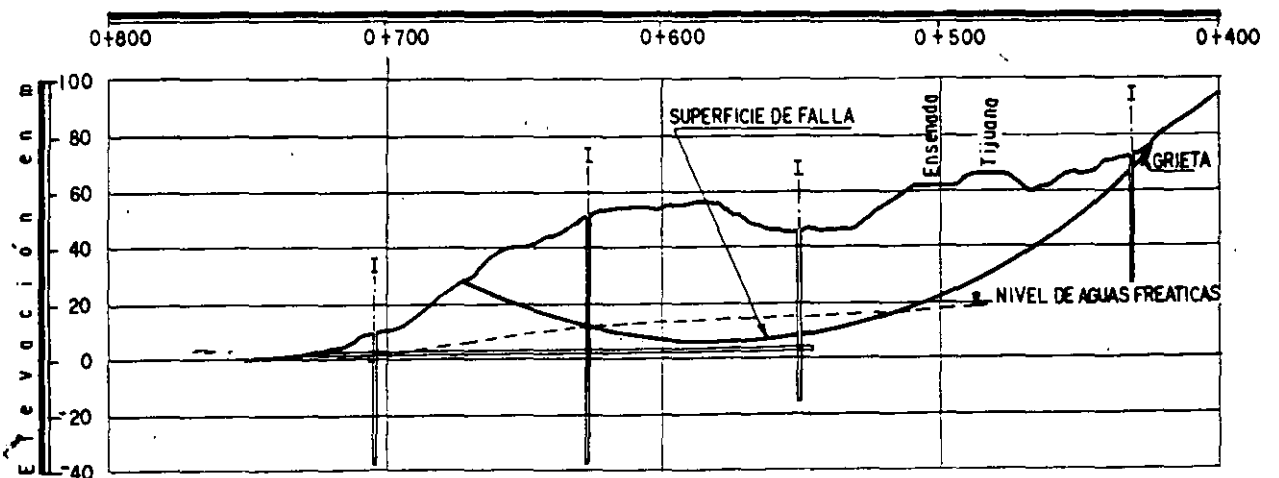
Perfil de la falla del km 15 + 500 de la autopista Tijuana-Ensenada, mostrando la galería filtrante (Ref. 30).
